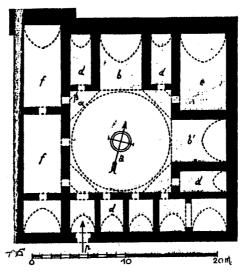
مسقط أفقي لمسجد امام بتهران . (عن : كنجنامه) .
